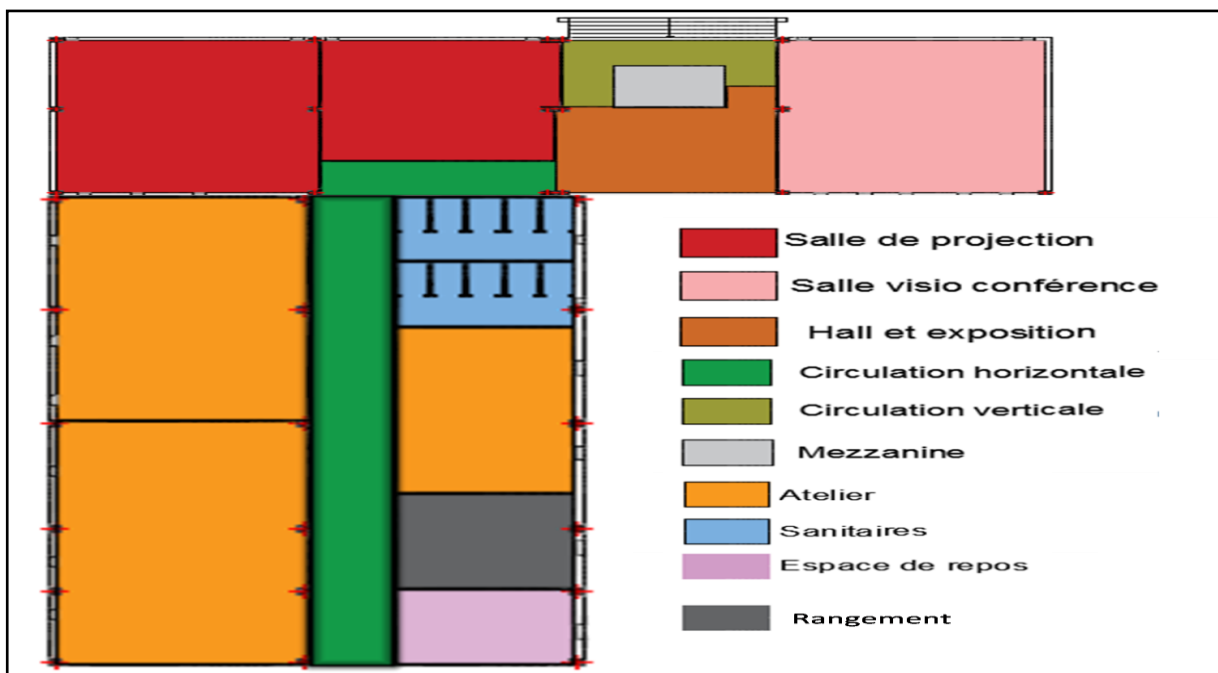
Plan du R+1 du bloc C Source : Auteurs
